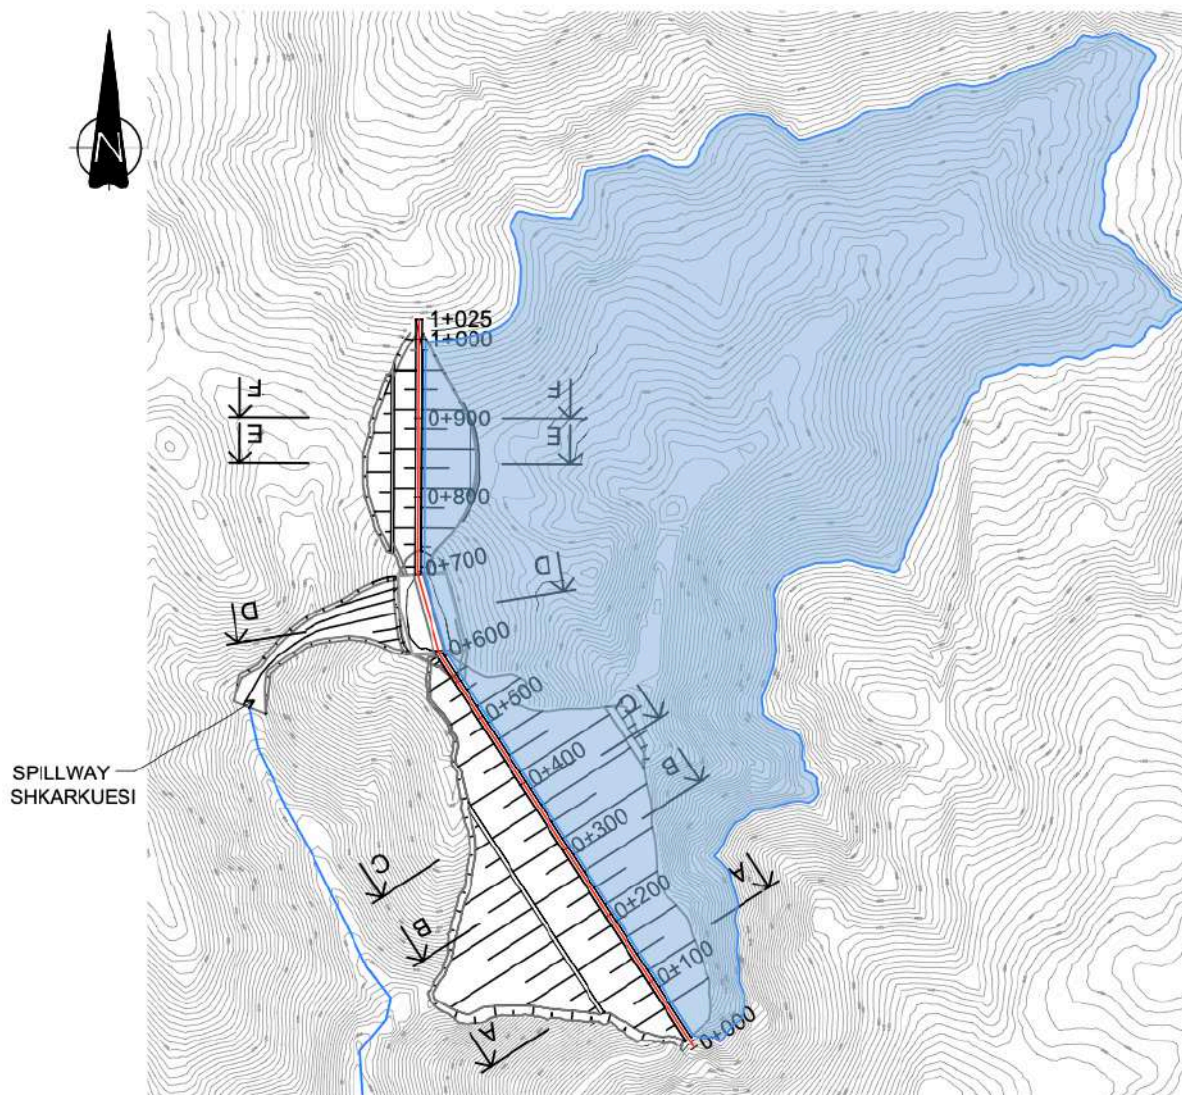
Planimetria e përgjithshme, diga kryesore dhe sekondare me ekran betoni (CFRD)
